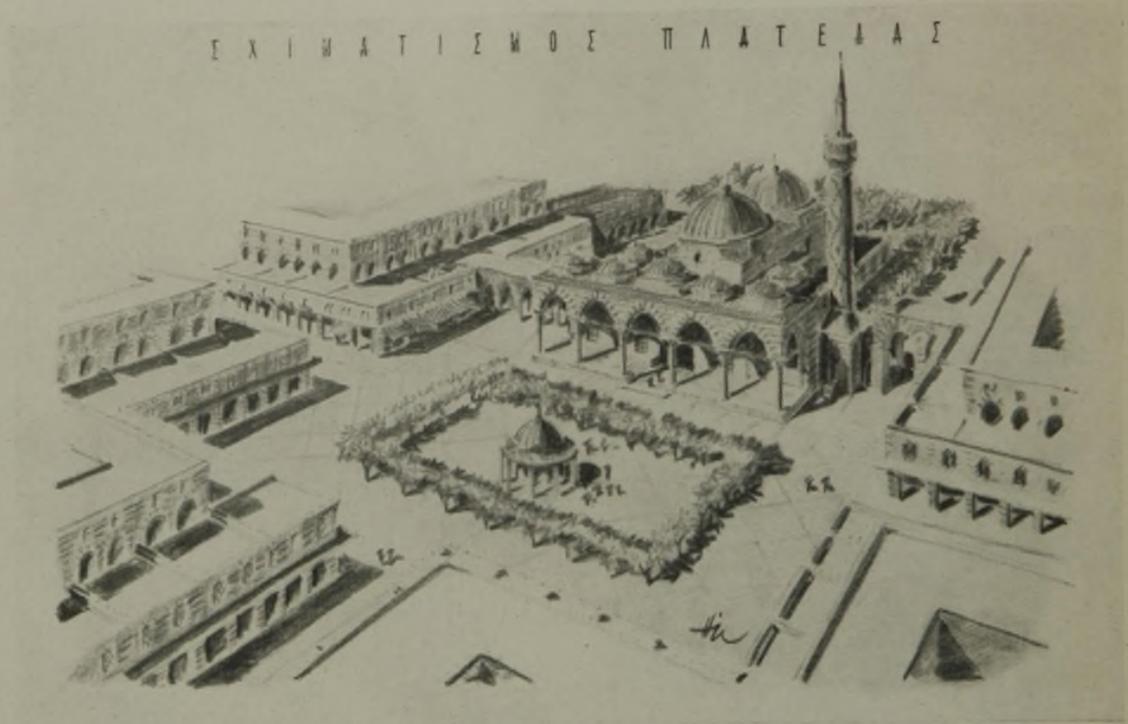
Einheitliche Platzbebauung um eine Moschee mit zurückgesetzten Aufbauten für Wohnungen, im Erdgeschoß Kolonnaden. Belebung des Platzes mit Brunnen- und Baumanlagen.
